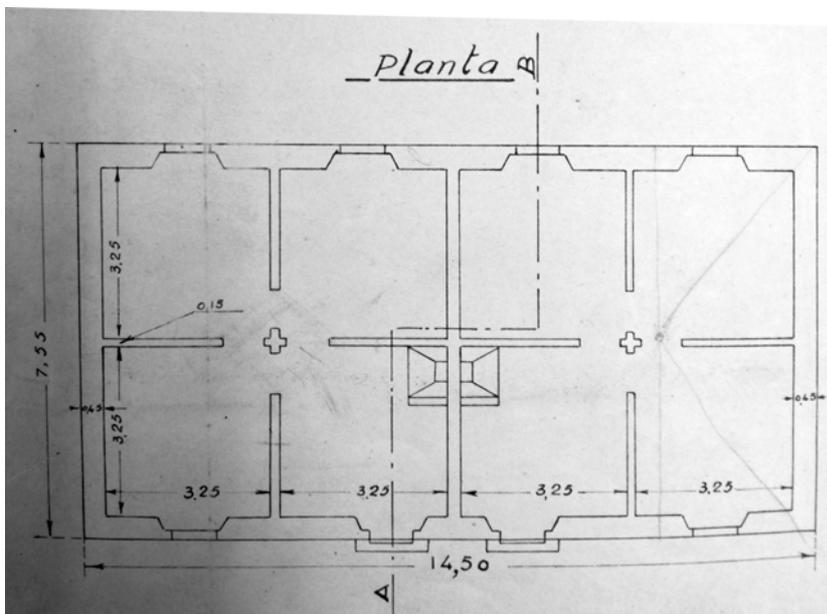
Planta Projeto tipo para as Casas dos Cantoneiros localizadas no Algarve, in Arquivo Distrital de Faro
